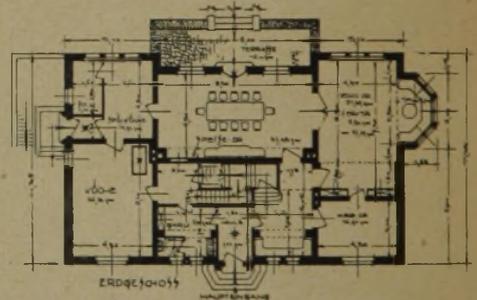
u. 18. Grundrißtyp für ein Obersten-Haus.
